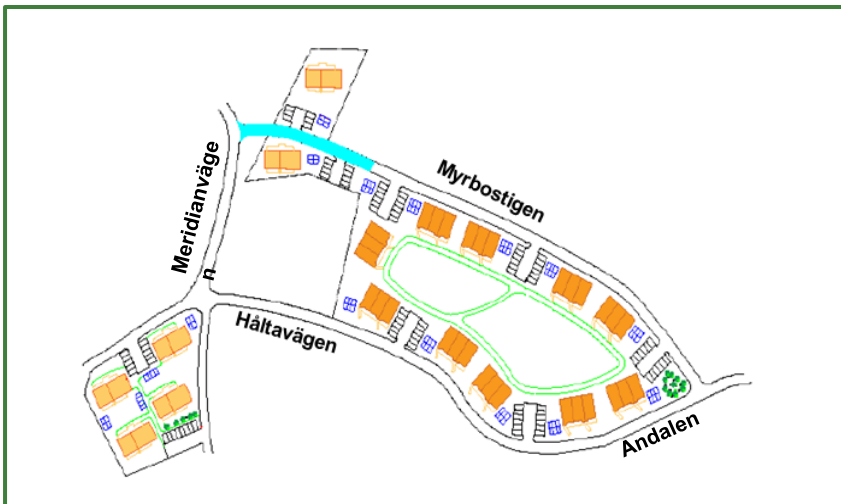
Skissförslag / Situationsplan med placering av byggnader.
